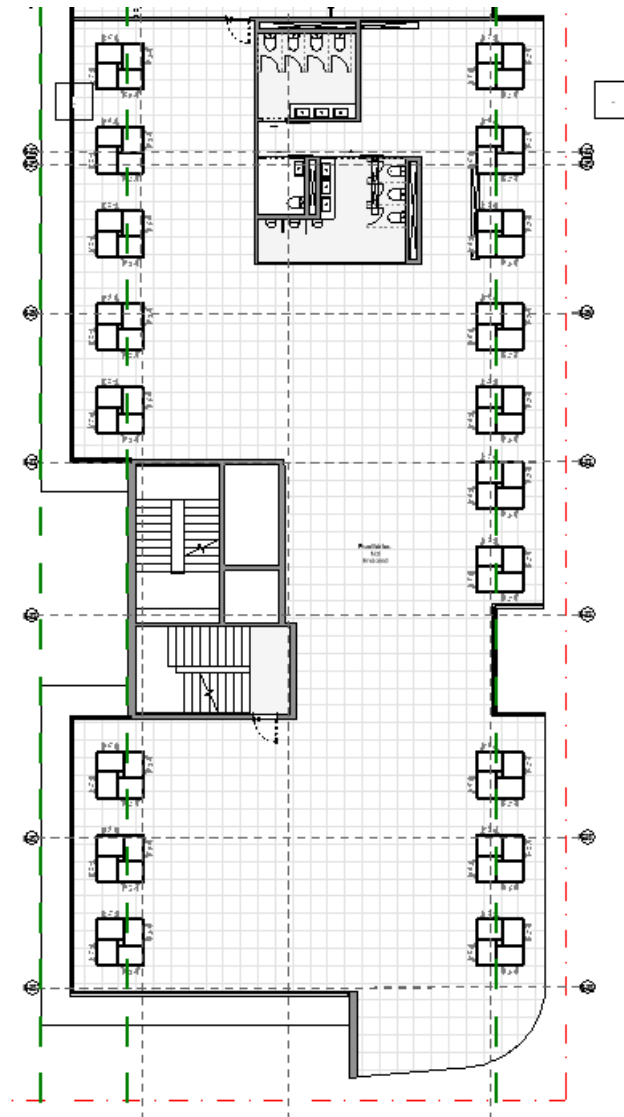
Planta de arquitetura – Piso 1 ao 3 (Revit)
